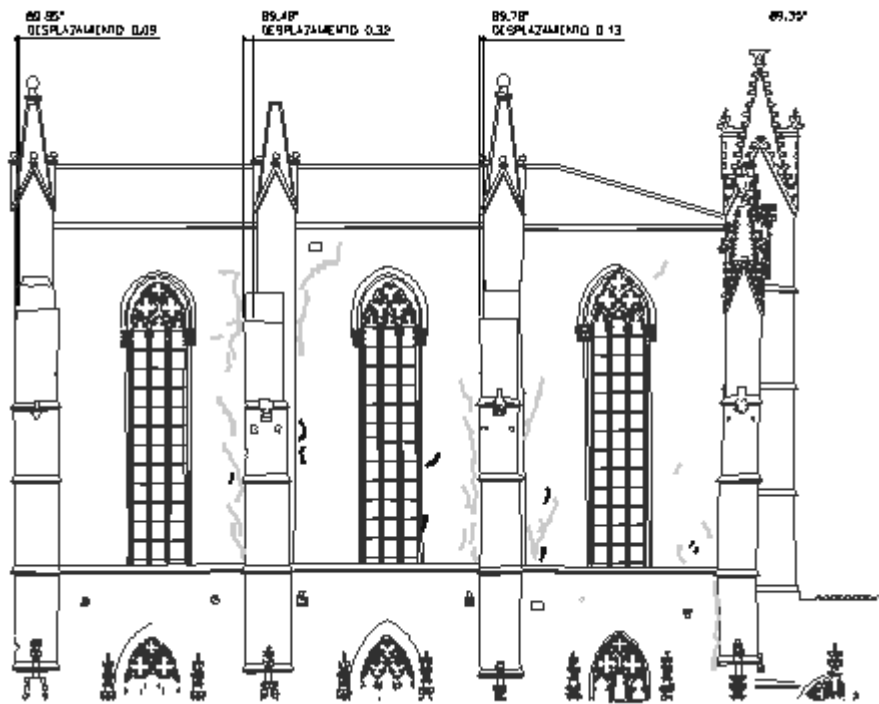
Fragmento del levantamiento obtenido en la fachada sur de la catedral de Palma de Mallorca, mostrando desplomes y grietas. E. Taltavull
